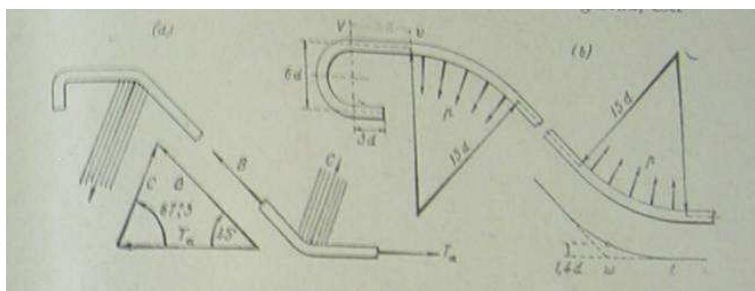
Detalle de doblado de barra longitudinal. (Zafra, 1911).
